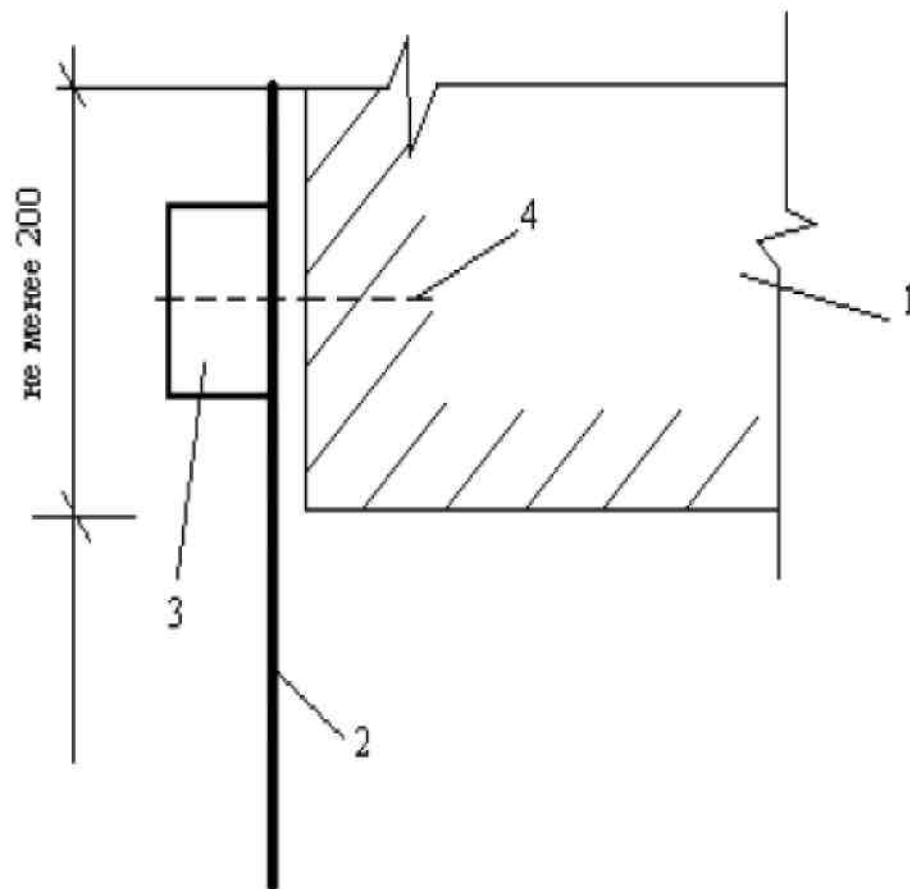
Кріплення плівки до зовнішньої стіни будівлі:
